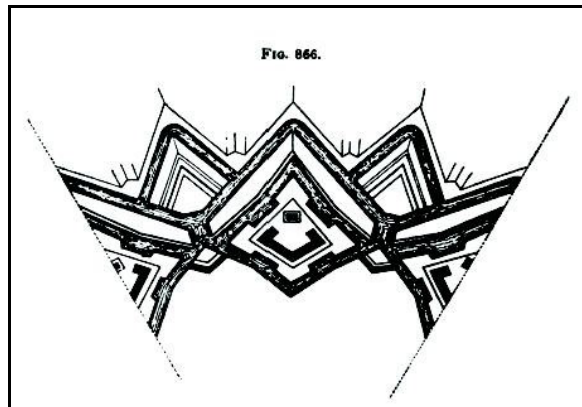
Escola Alemã – Sturm. Planta de Fortificação. Ibidem, pág..506.
